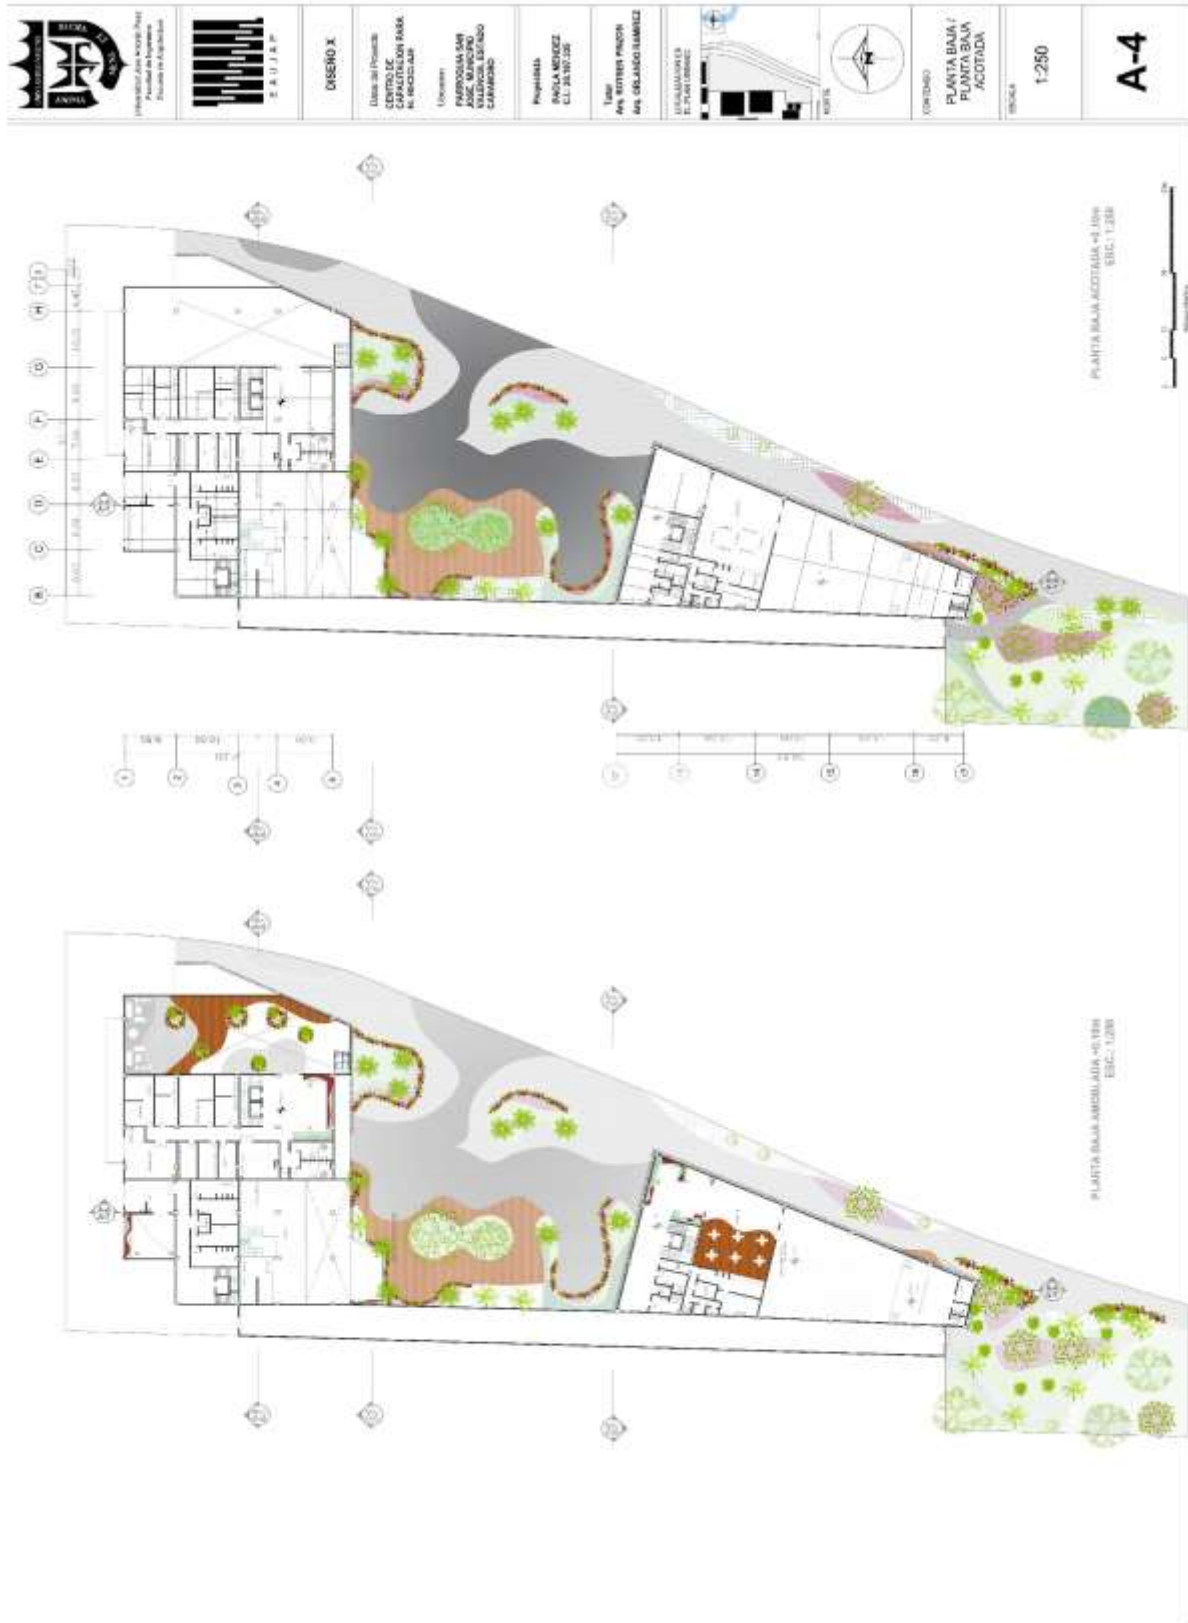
A-4 Planta Baja/Planta Baja Acotada Fuente: La Autora (2023)
